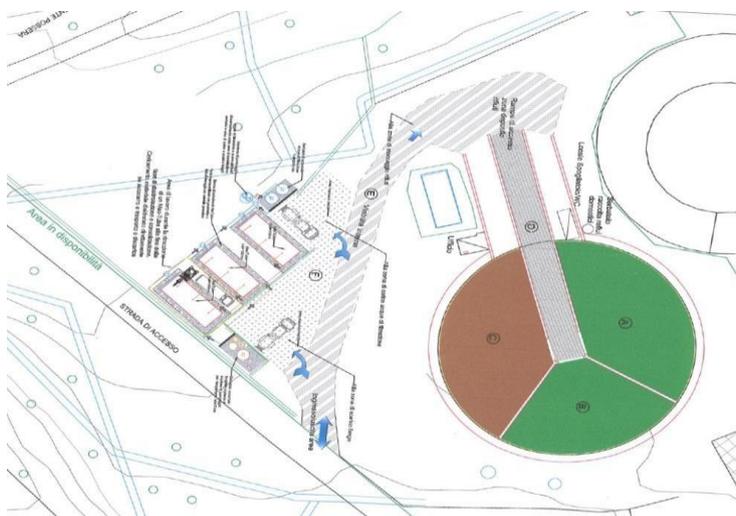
Planimetria Stoccaggio Sito Pomaranace
